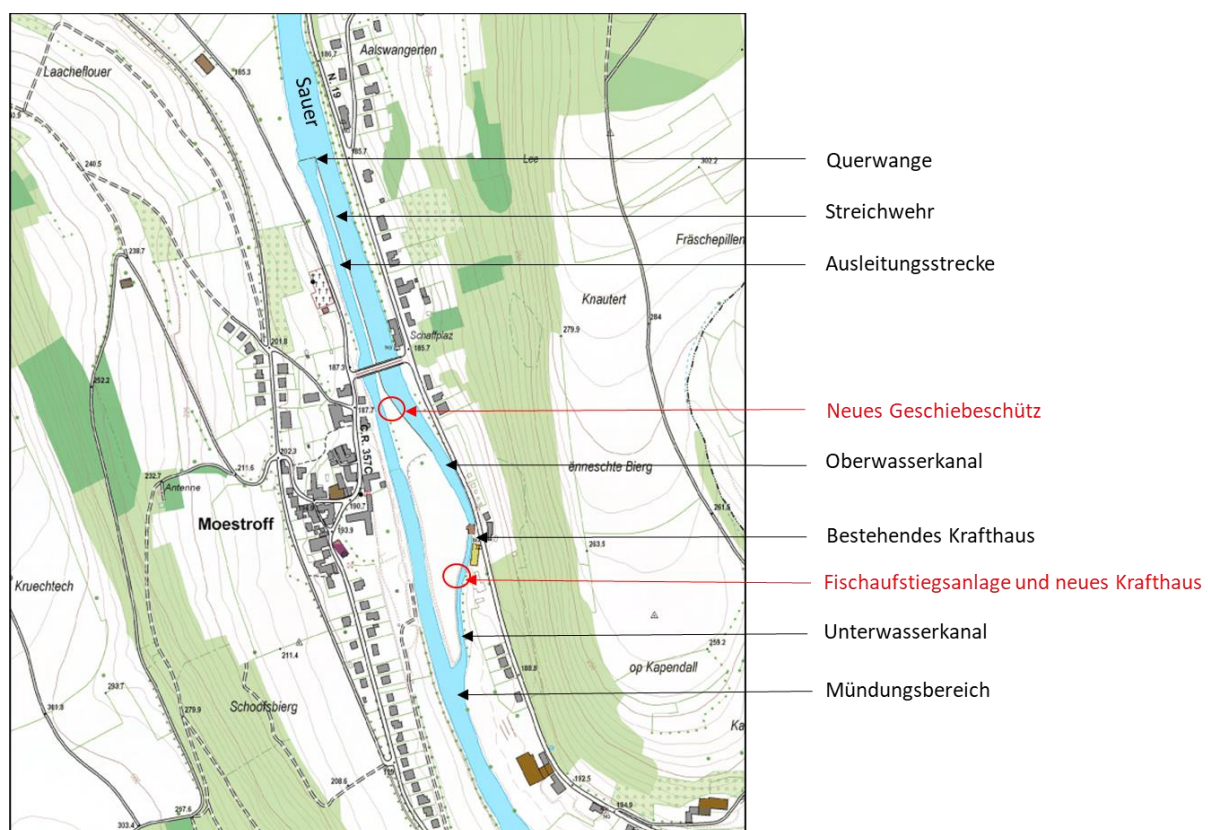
Lageplan der bestehenden und geplanten Wasserkraftanlage [3].
